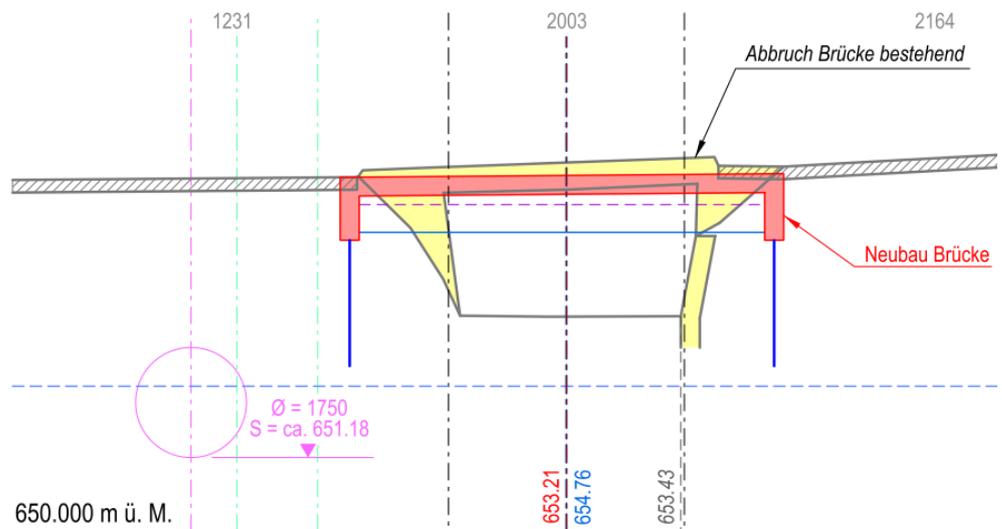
Chise Brücke Thunstrasse bei QP m 941.90: Neubau
